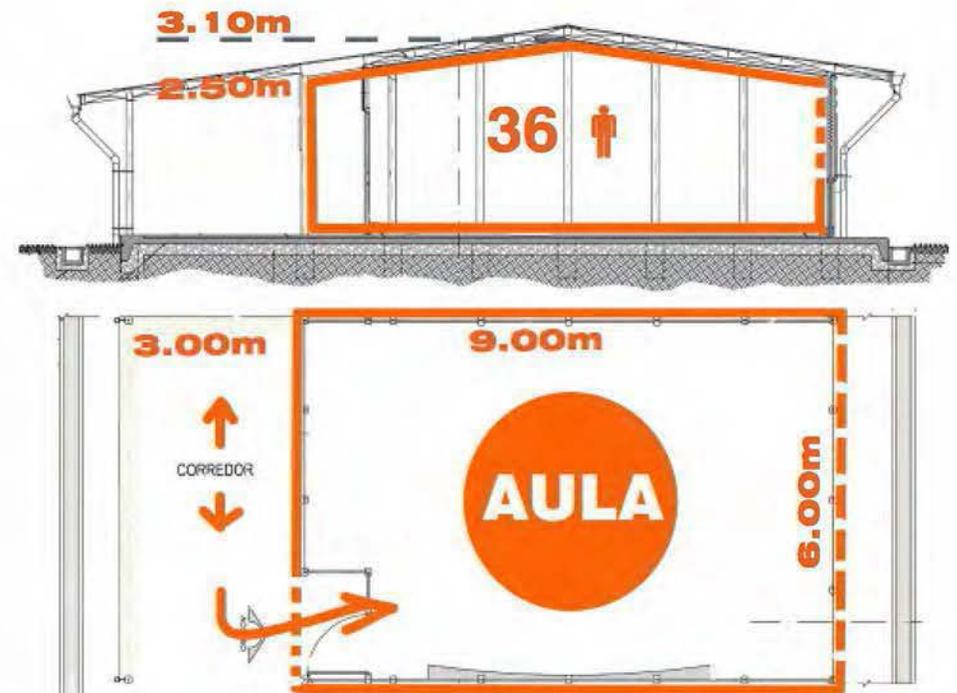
Diagrama en planta y elevación de aula típica de baldosas de concreto en LMVA.. Elaborado por autor
